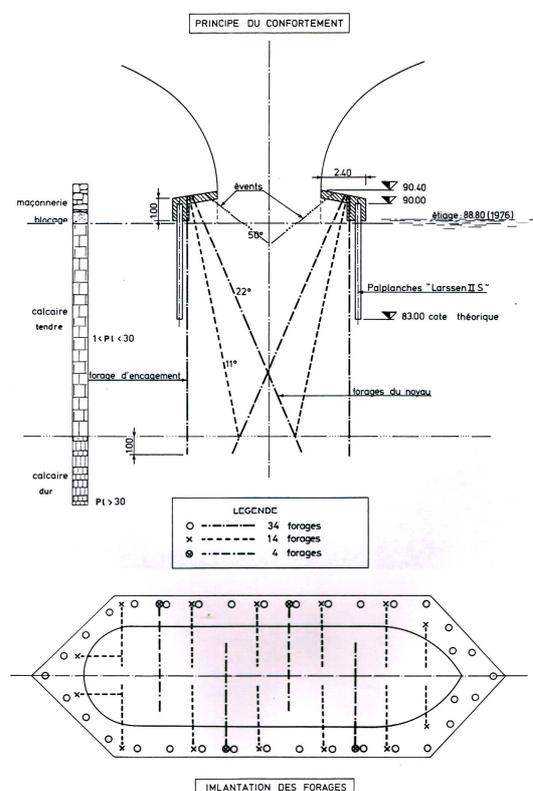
Principe du confortement des fondations anciennes avec un rideau périphérique de palplanches métalliques, tenues entre elles par des clefs, des injections périphériques pour prolonger le rideau de palplanches, des injections du noyau pour remplir les vides. Le battage des palplanches se fait avec un vibreur à moteur excentrique qui nécessite moins de hauteur libre que le mouton diesel plus classique, mais qui est plus haut, puisqu'il est constitué d'une masse d'environ une tonne sous un piston qui bat les palplanches et pour qu'il remonte on injecte du gazoil lors de la descente de la masse, il y a alors compression du mélange air/gazoil et donc explosion au moment de la frappe, ce qui est le principe de fonctionnement d'un moteur diesel. C'est lui qui a été utilisé pour les fondations du nouveau pont de Sully. Sous les arches, compte tenu de la hauteur disponible, les palplanches doivent être battues en deux éléments raccordés par des entures (c'est-à-dire des soudures) pour assurer la continuité du rideau.
